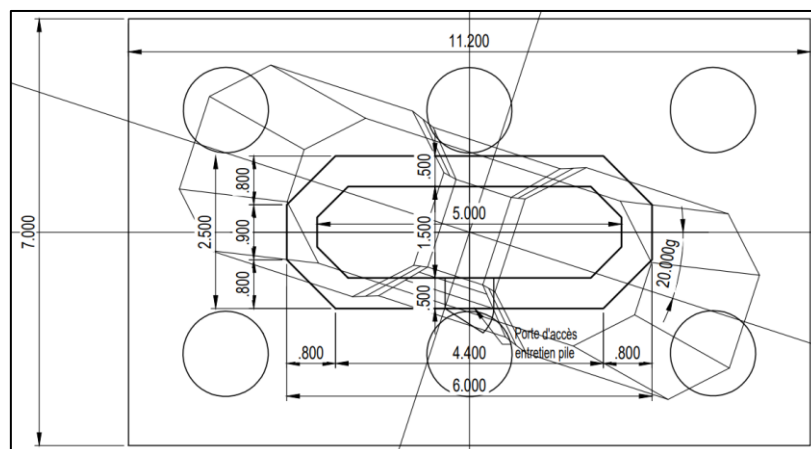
Vue en plan pieds piles P2 et P5 viaduc de Vienne
